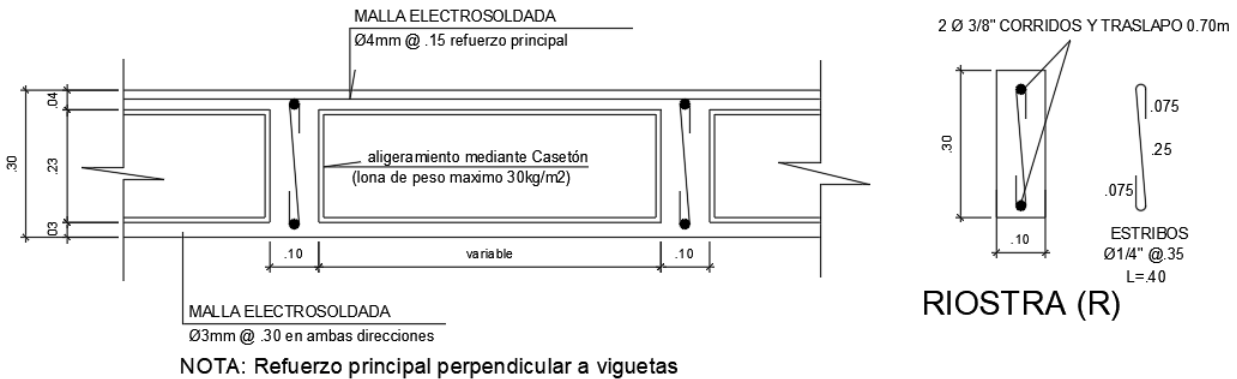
Detalle losa de entepiso. Fuente: Propia
